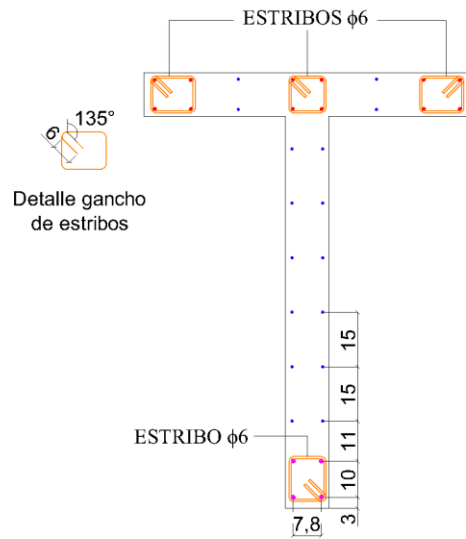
Plano (con vista en elevación) del muro de ensayo ET1.
